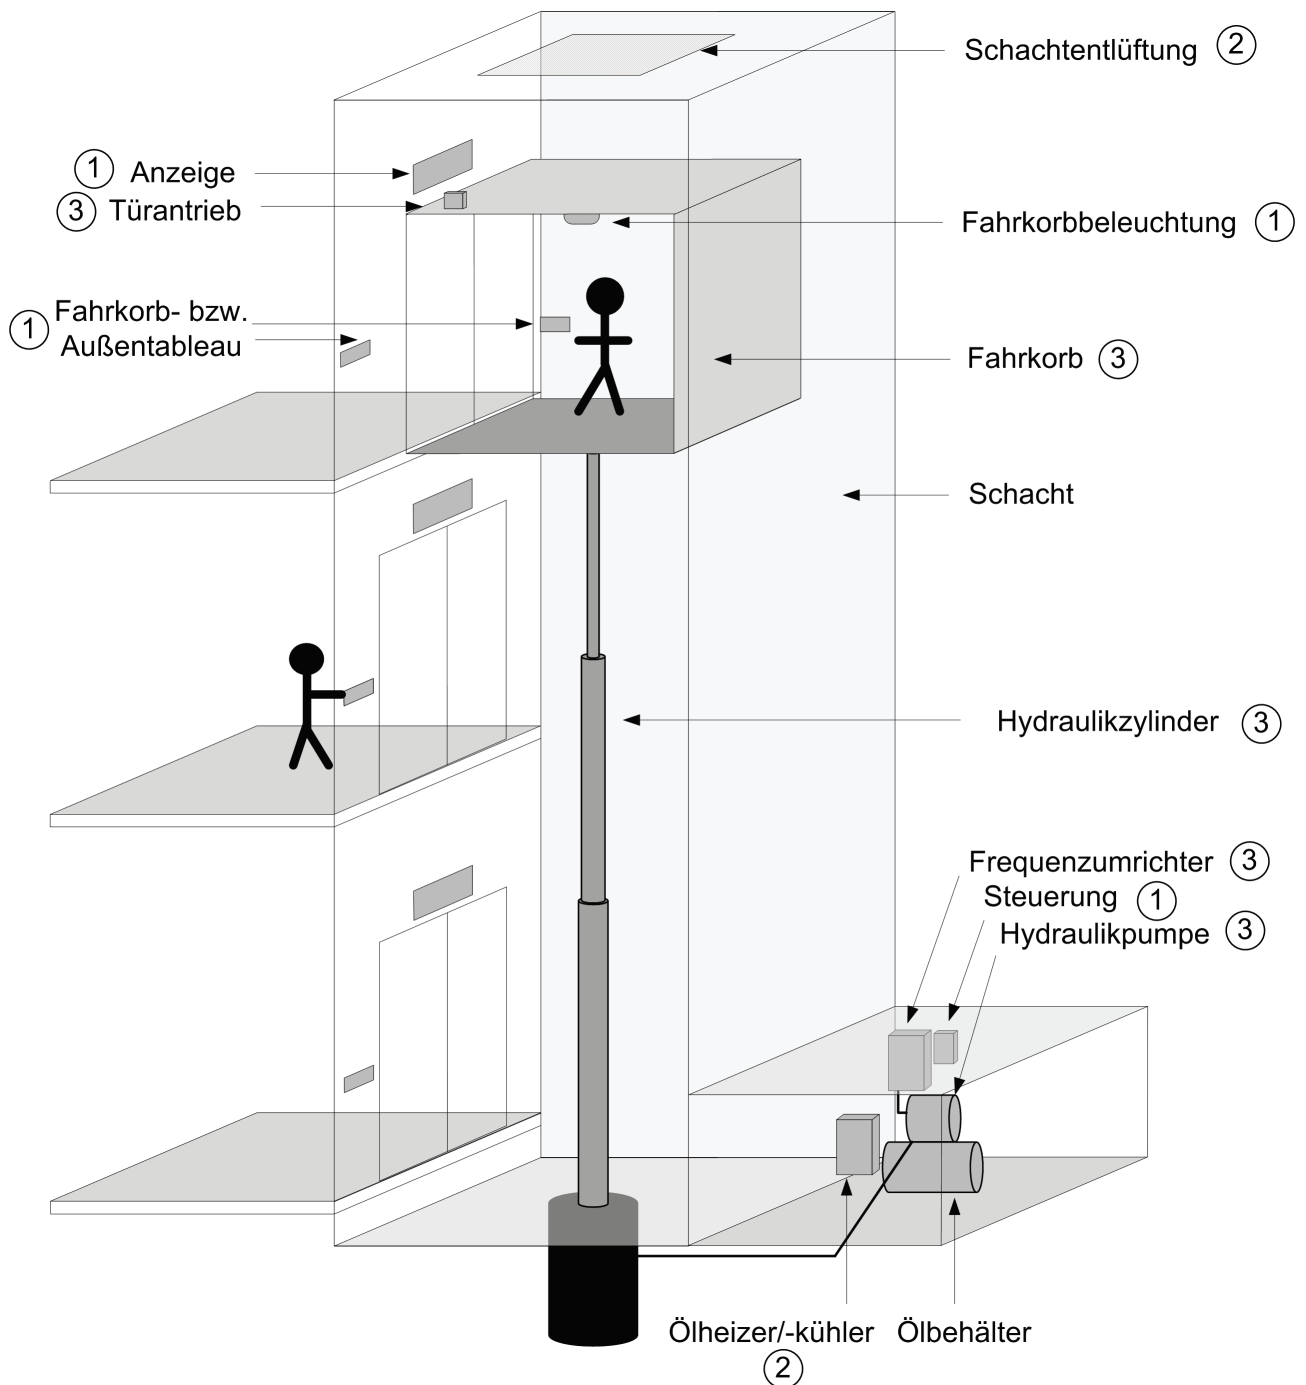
Komponenten des Referenzaufzugs (hier: Hydraulikaufzug) – Übersicht
